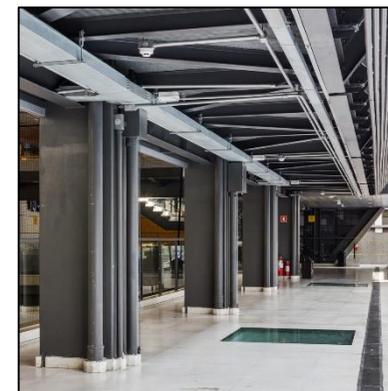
Pilares de concreto e estrutura metálica da laje
